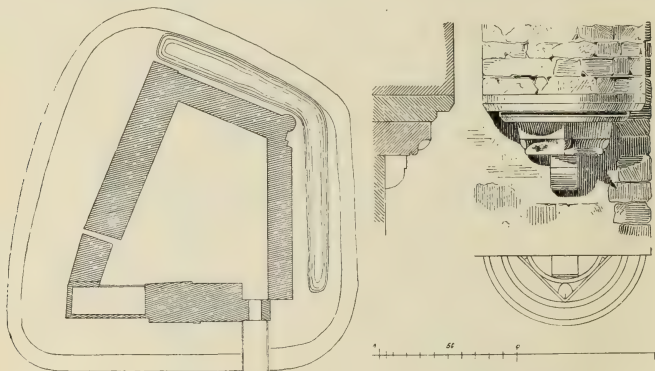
Burg Irnich. Lageplan und Details des Thorbaues.
